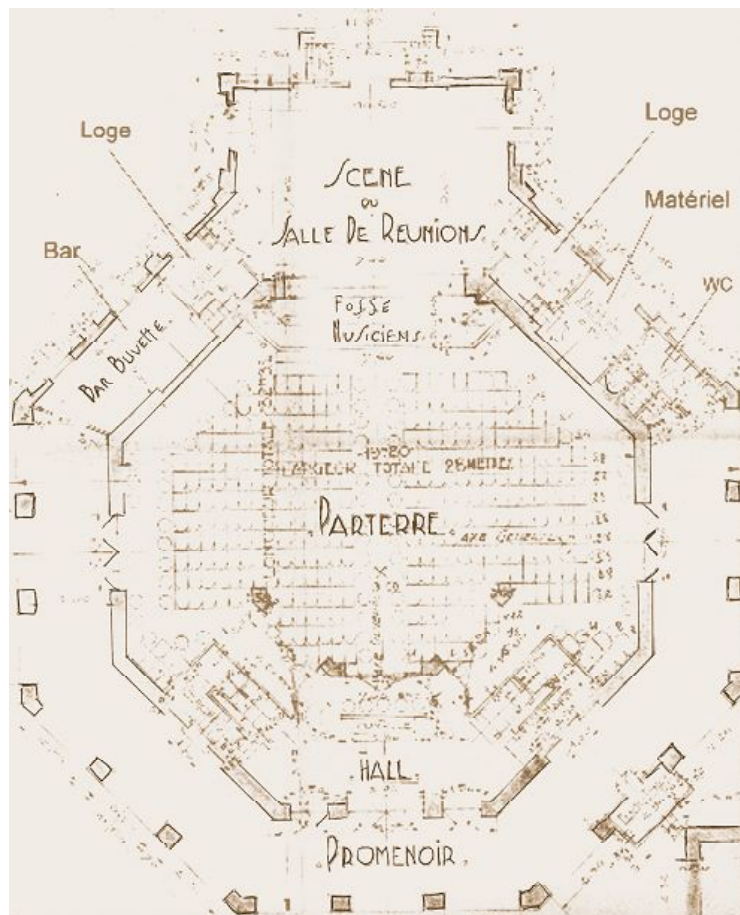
Plan détaillé du rez-de-chaussée - Arch. mun. Aire - 3 M 161
